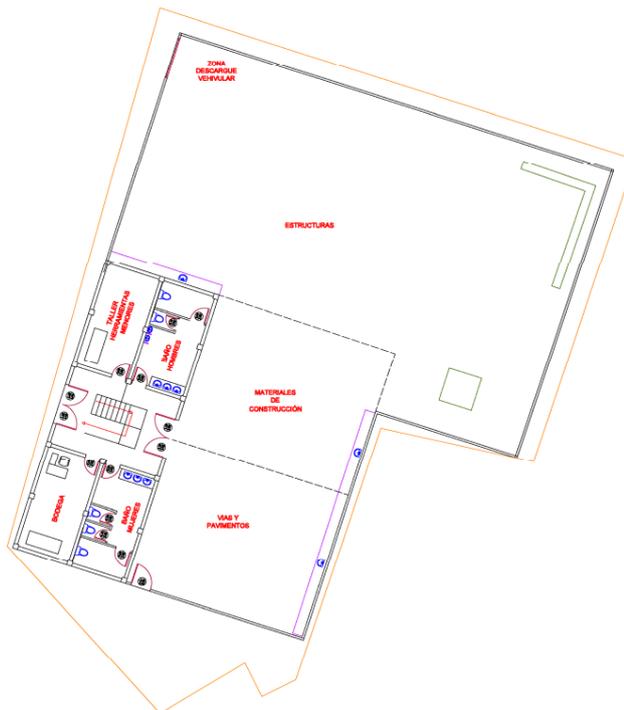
Diseño arquitectónico - Planta baja [autoría propia]
